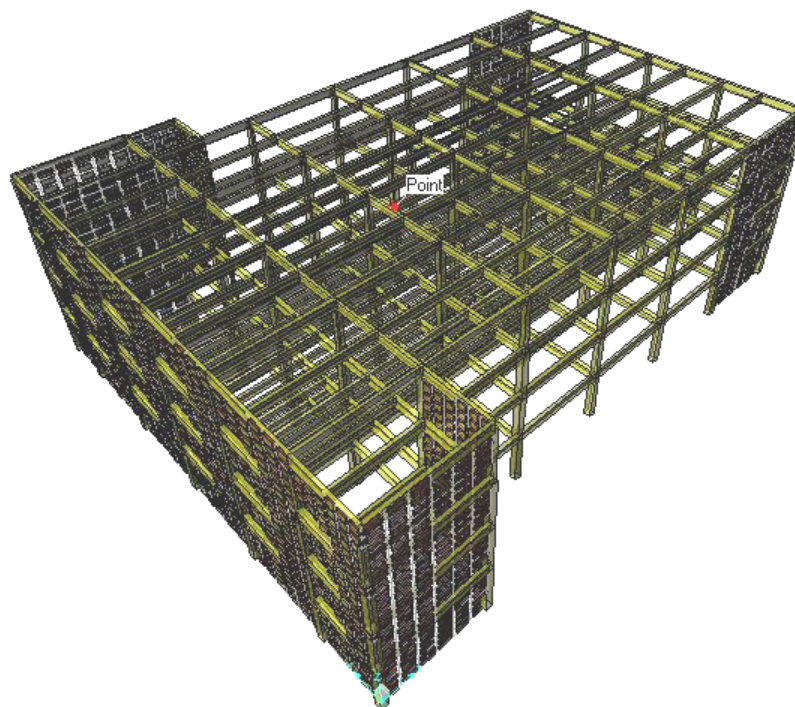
Modelo con estructural con la participación de muros de mampostería.
